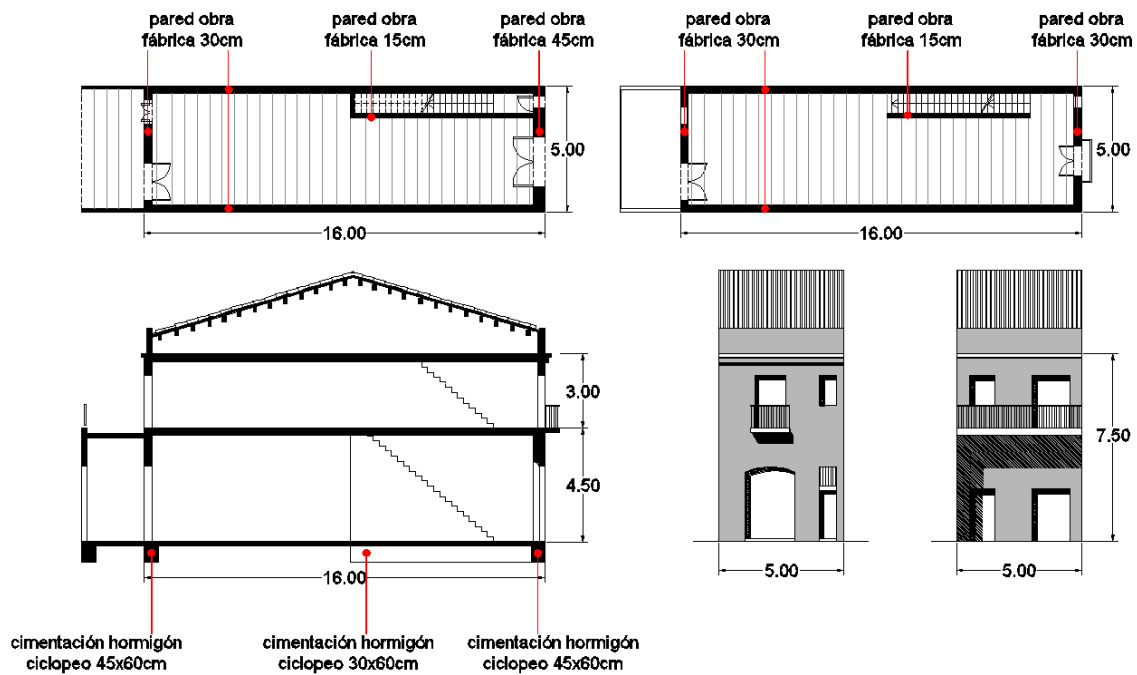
a Plantas, alzados y sección del modelo I.1
